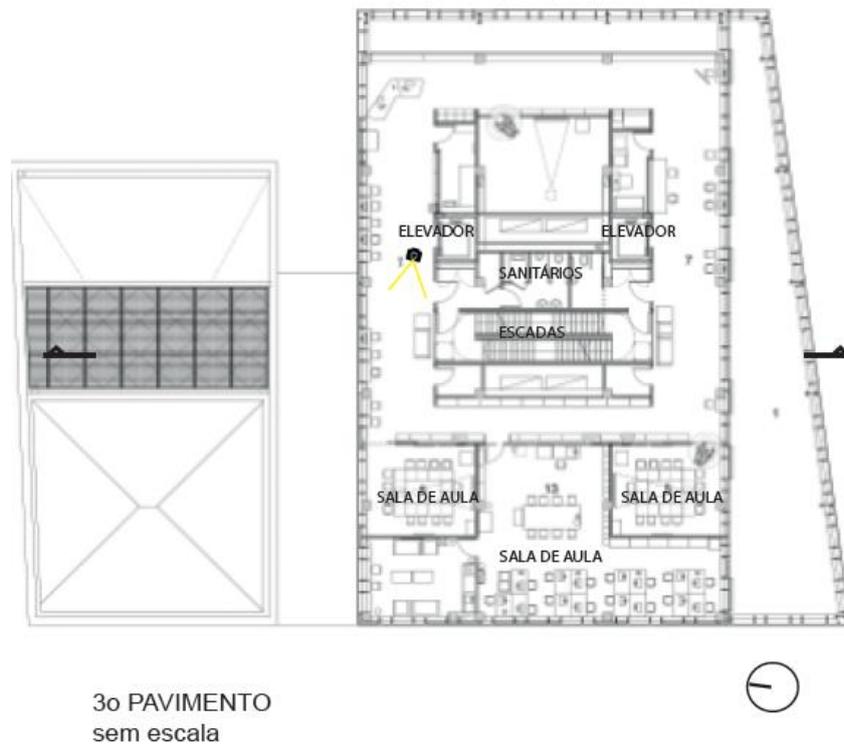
Planta do Terceiro Pavimento da *Idea Store Whitechapel* (LI, 2013)
